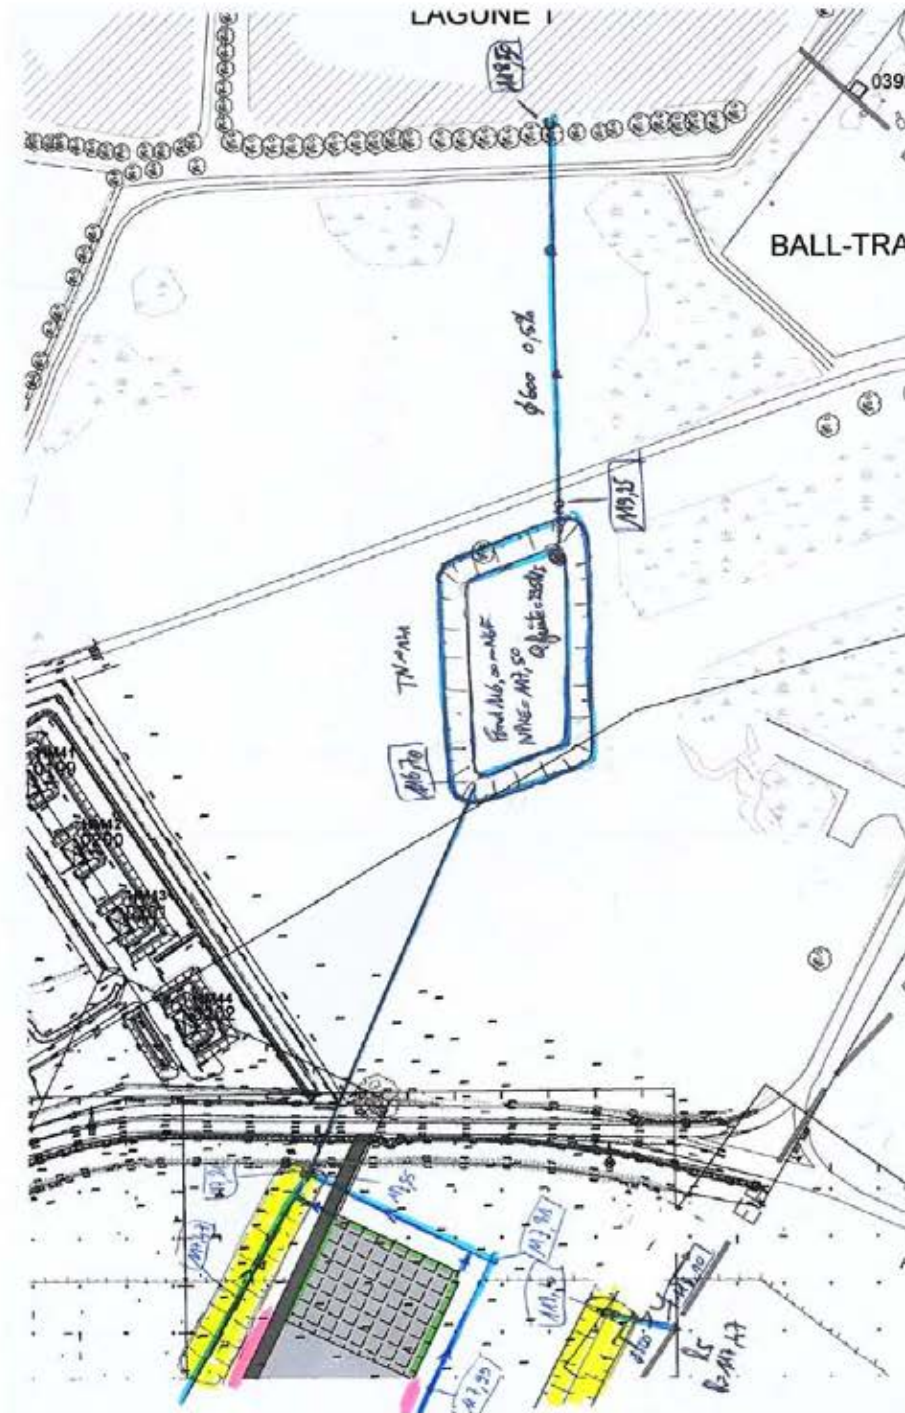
Plan de principe d'aménagement d'un nouveau bassin
